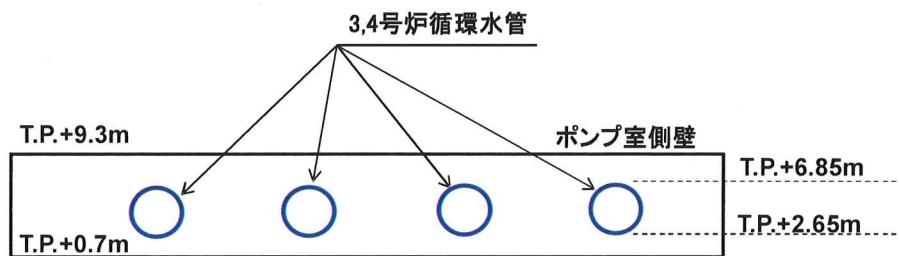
3, 4号炉循環水管埋設部①断面図
